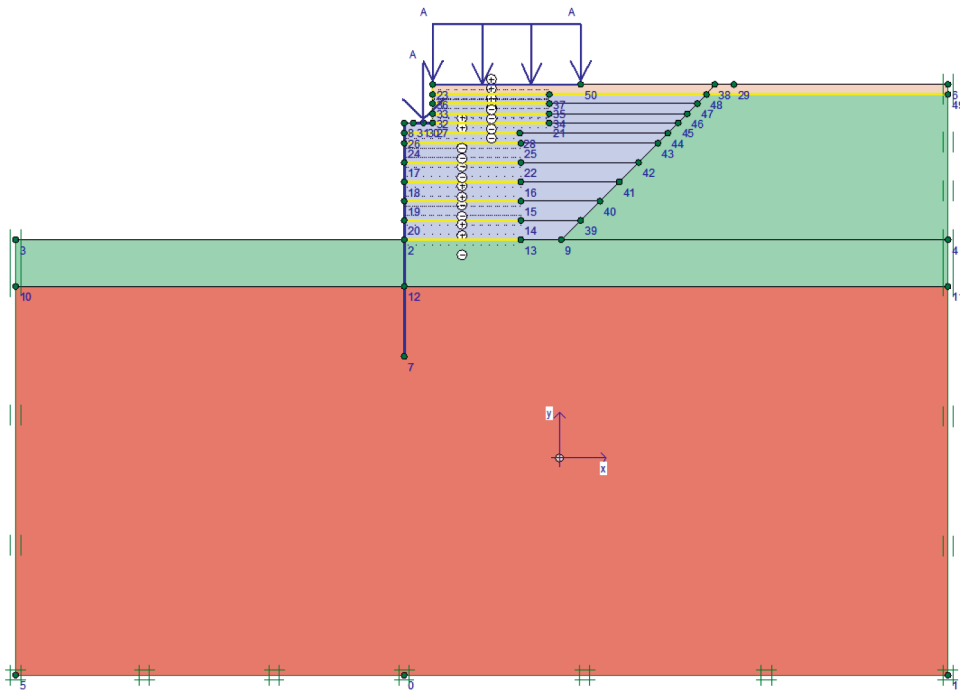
Расчетная схема армогрунтового устоя (А – вертикальная нагрузка)
